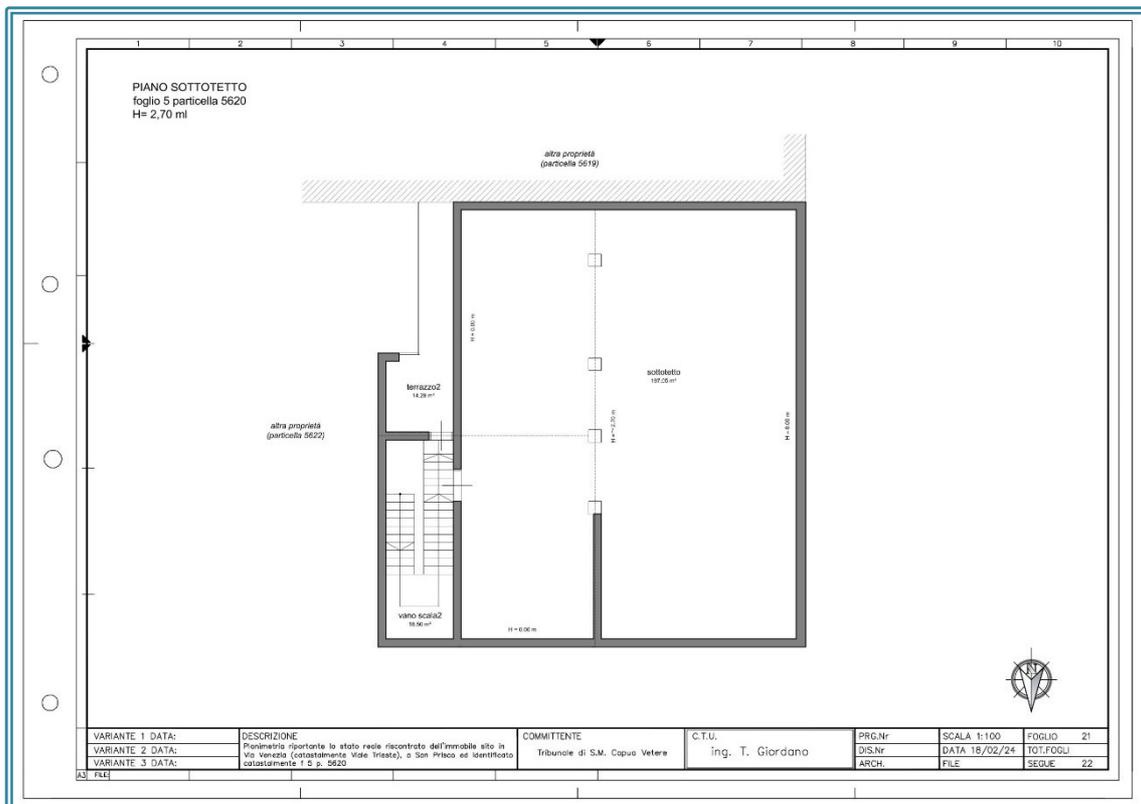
Piano sottotetto LOTTO 13 stato attuale
